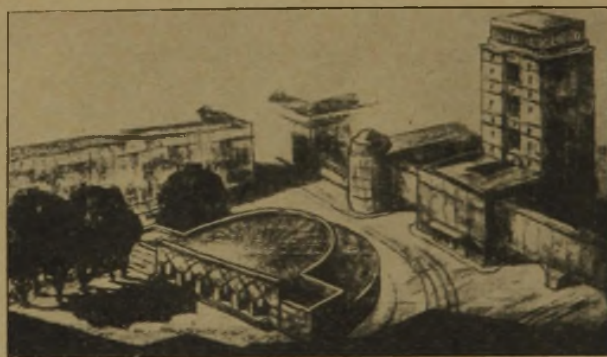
Verf. Arch. Rud. Schnell (Lageplan Abb. 19).
